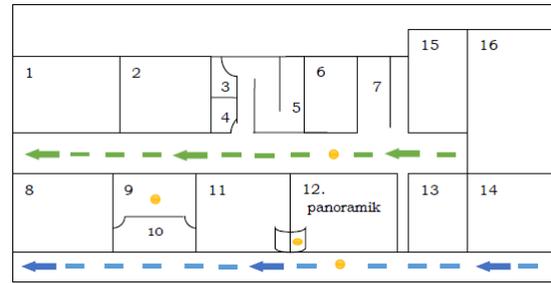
Denah Titik Pengukuran Ruang Pesawat Panoramik
